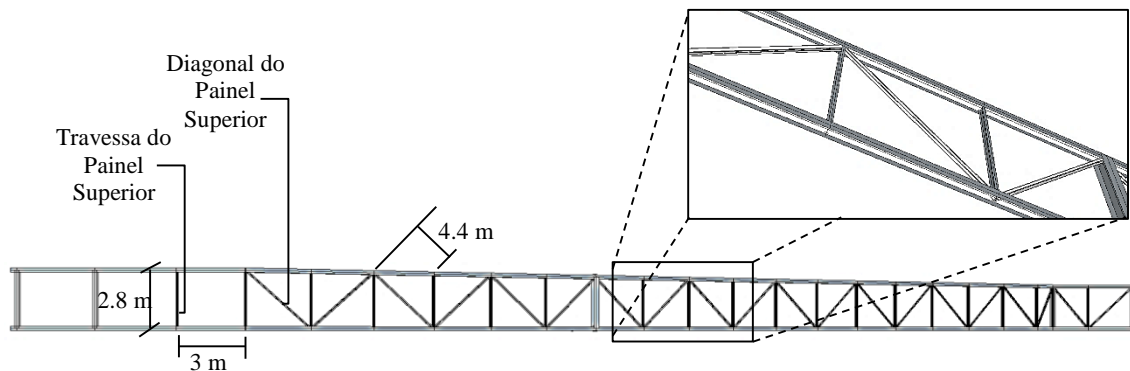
Diagonais e Travessas do Painel Horizontal Superior - Planta
